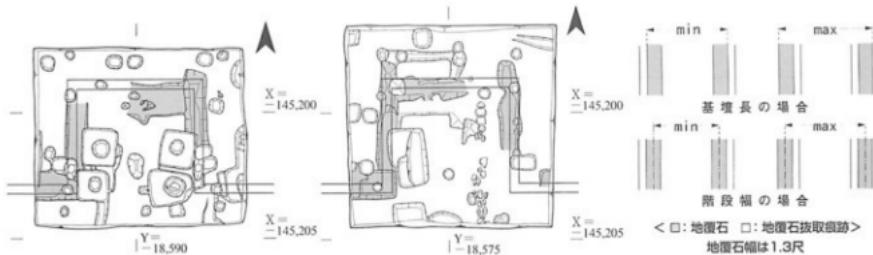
B区（北面中央階段）造構平面図 1:200 図25 C区（北面東階段）造構平面図 1:200
